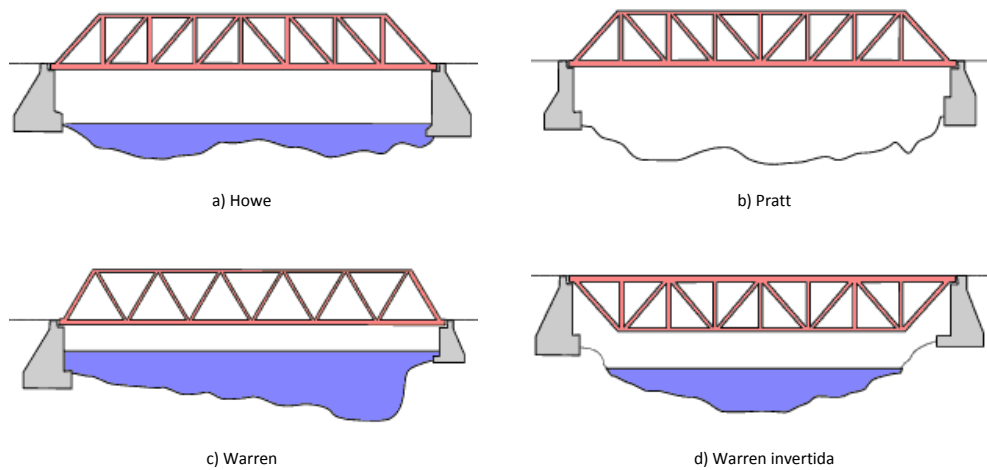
Superestrutura - tipos de vigas em treliça
